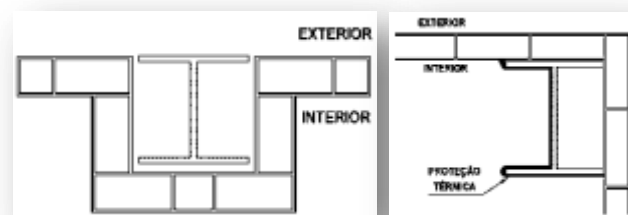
Pilar interno incorporado às paredes.Figure 3: Internal Pillar incorporated into walls.Fonte: [Andrade \(2010, p. 116\)](#)
